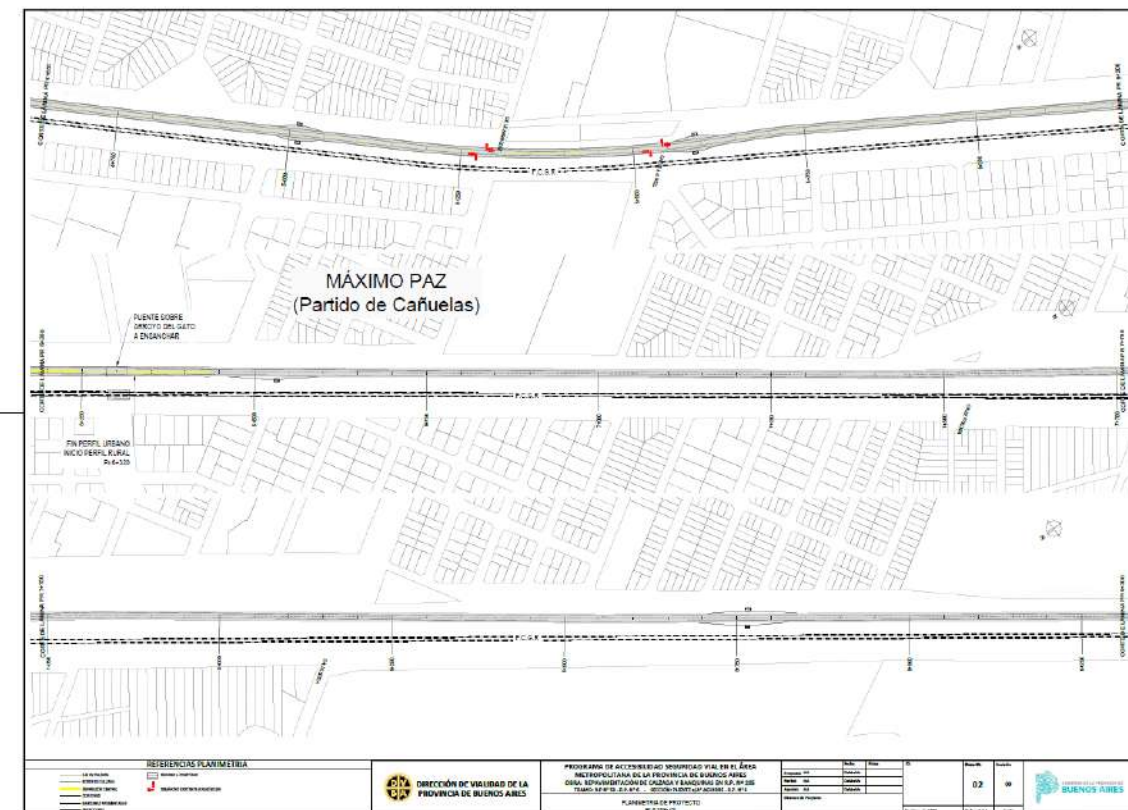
Planimetría de Proyecto RPN°205 (2)
